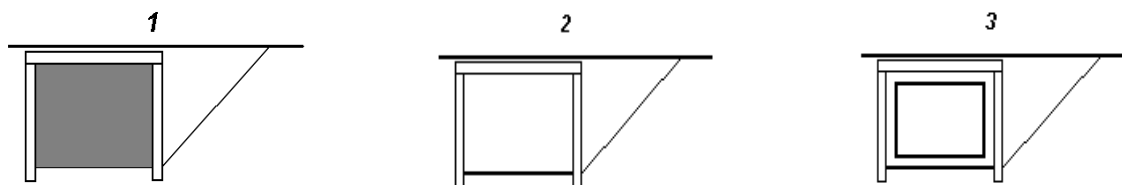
Схема разработки грунта под мостовыми перекрытиями без прекращения уличного движения
